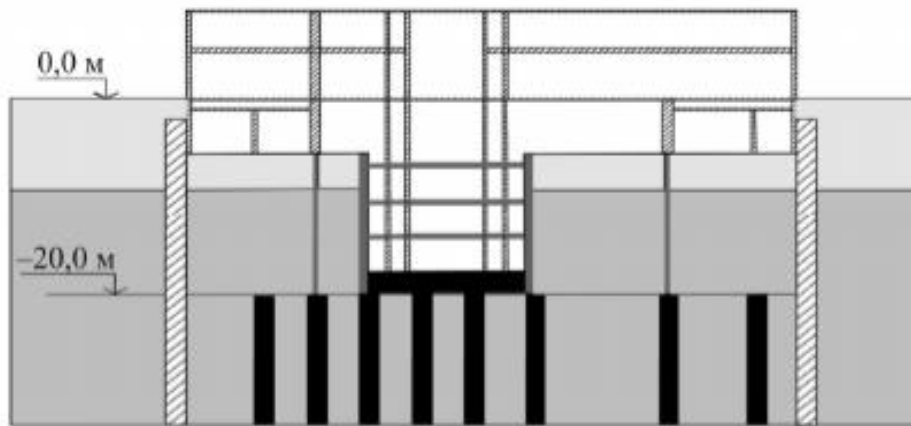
Порядок производства работ по методу «сверху-вниз» на 3-м этапе: выемка грунта на этаже –4; бетонирование перекрытия на этаже –5; завершение этажа –3; возведение этажей 1–4
